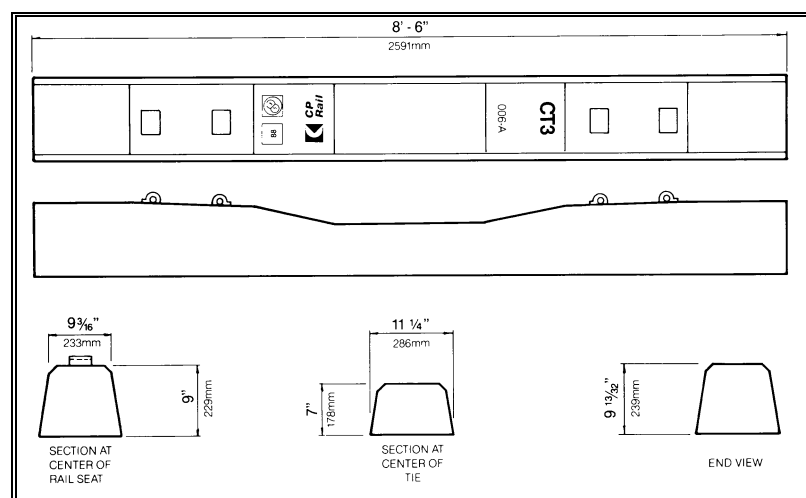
Dormente modelo CT3 para via de transporte pesado (FONTE: CXT CONCRETE RAILROAD TIES - 1996).
